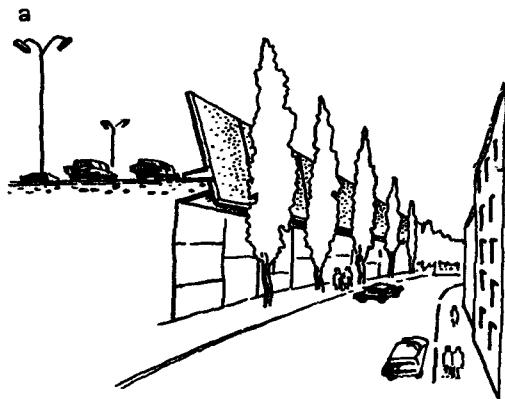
Бетонный экран с насаждениями вдоль автодороги A4 в Реймсе
